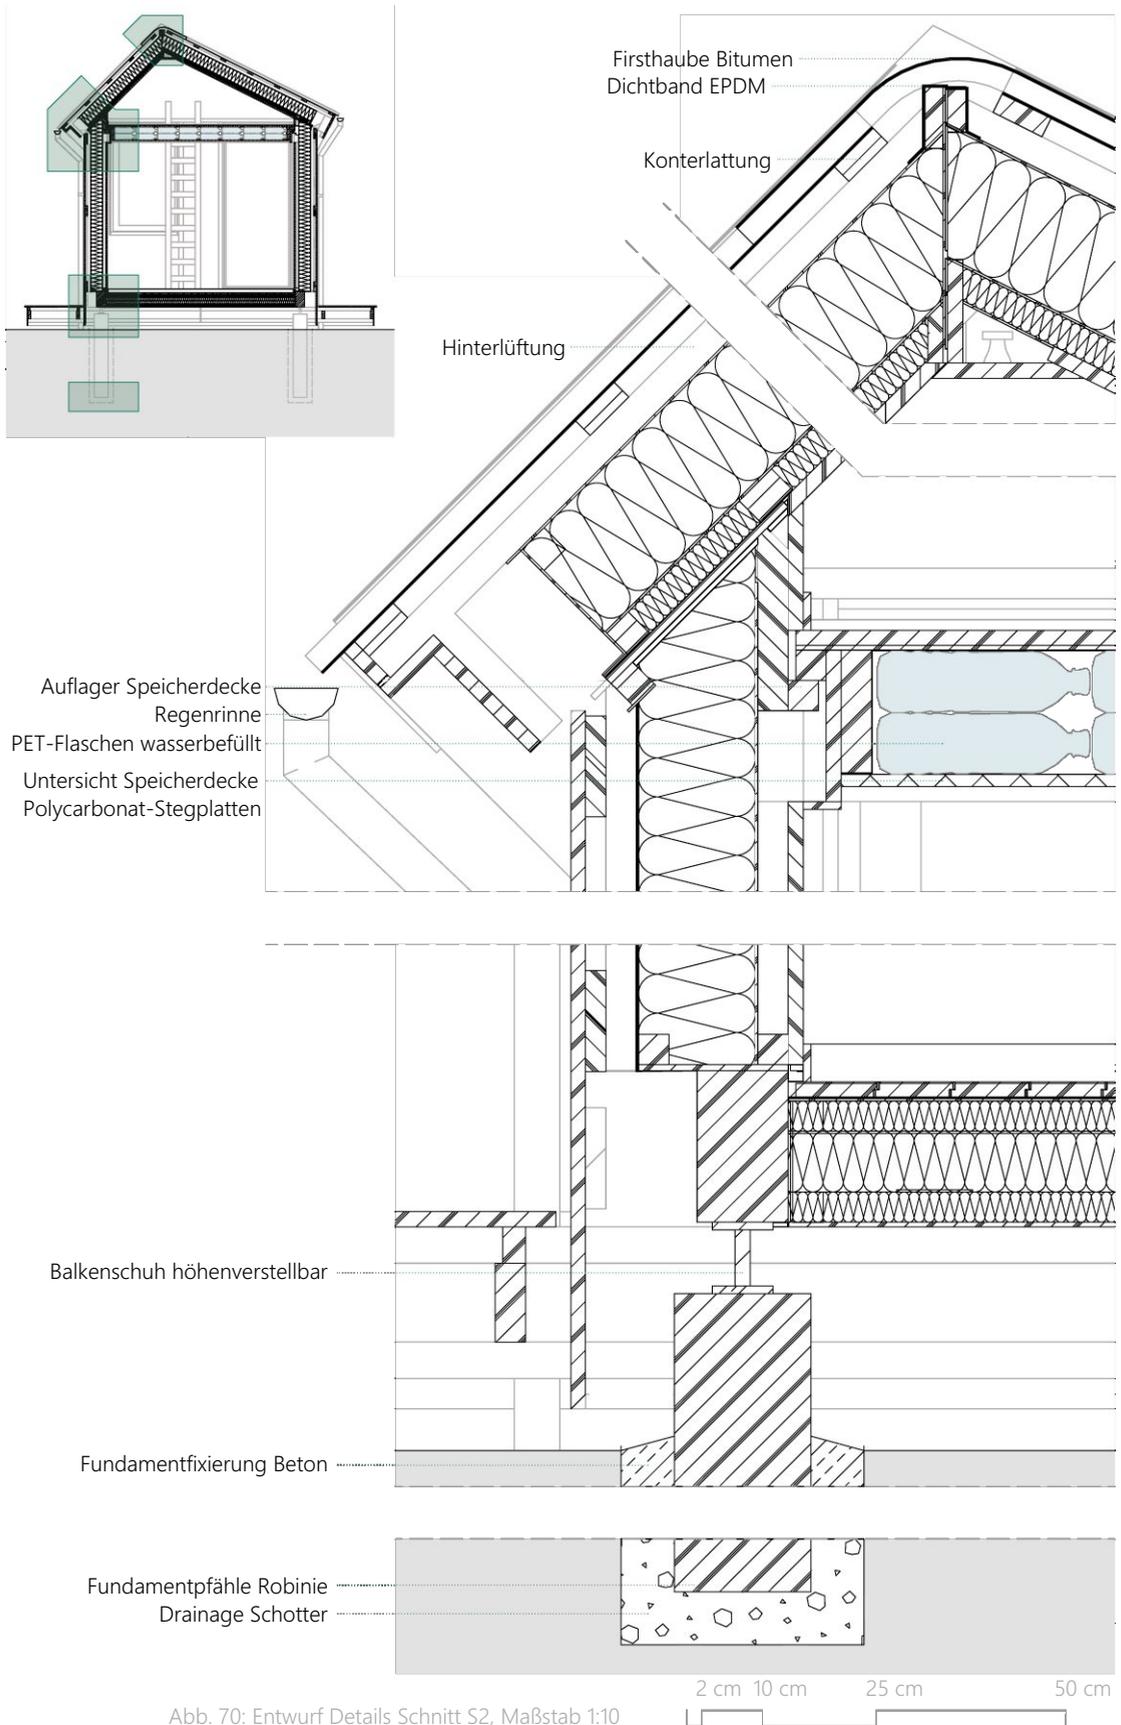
Entwurf Details Schnitt S2, Maßstab 1:10
